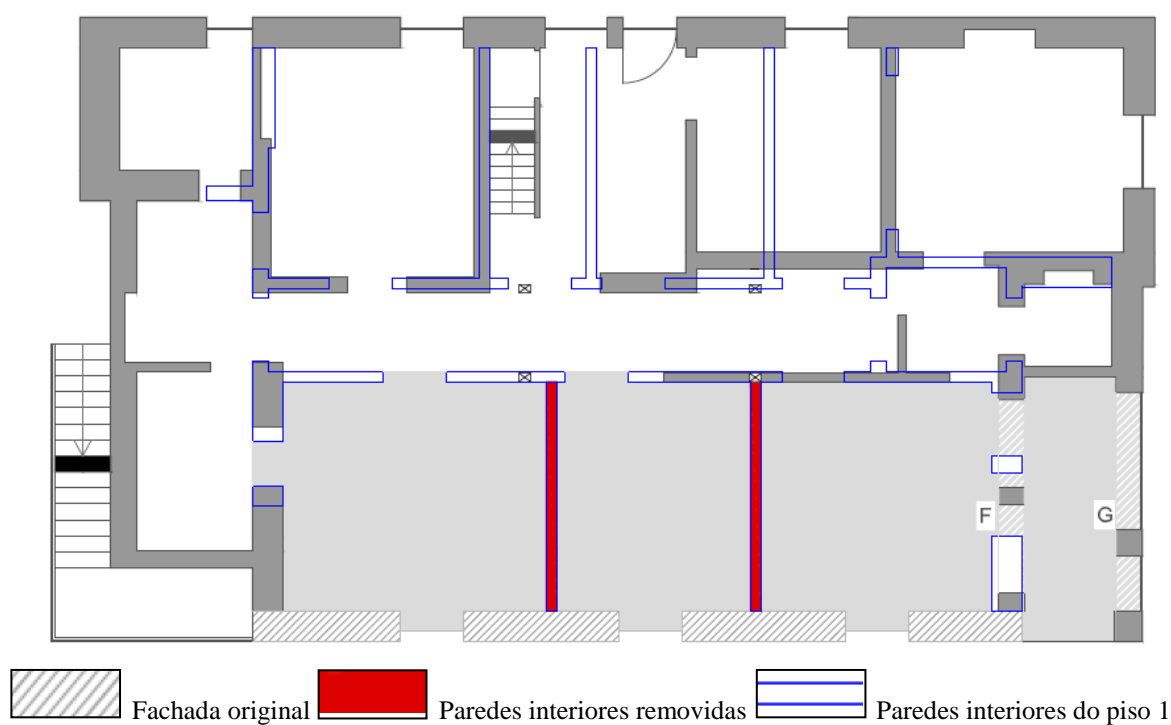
Planta com sobreposição das paredes interiores do piso 1. Piso térreo
